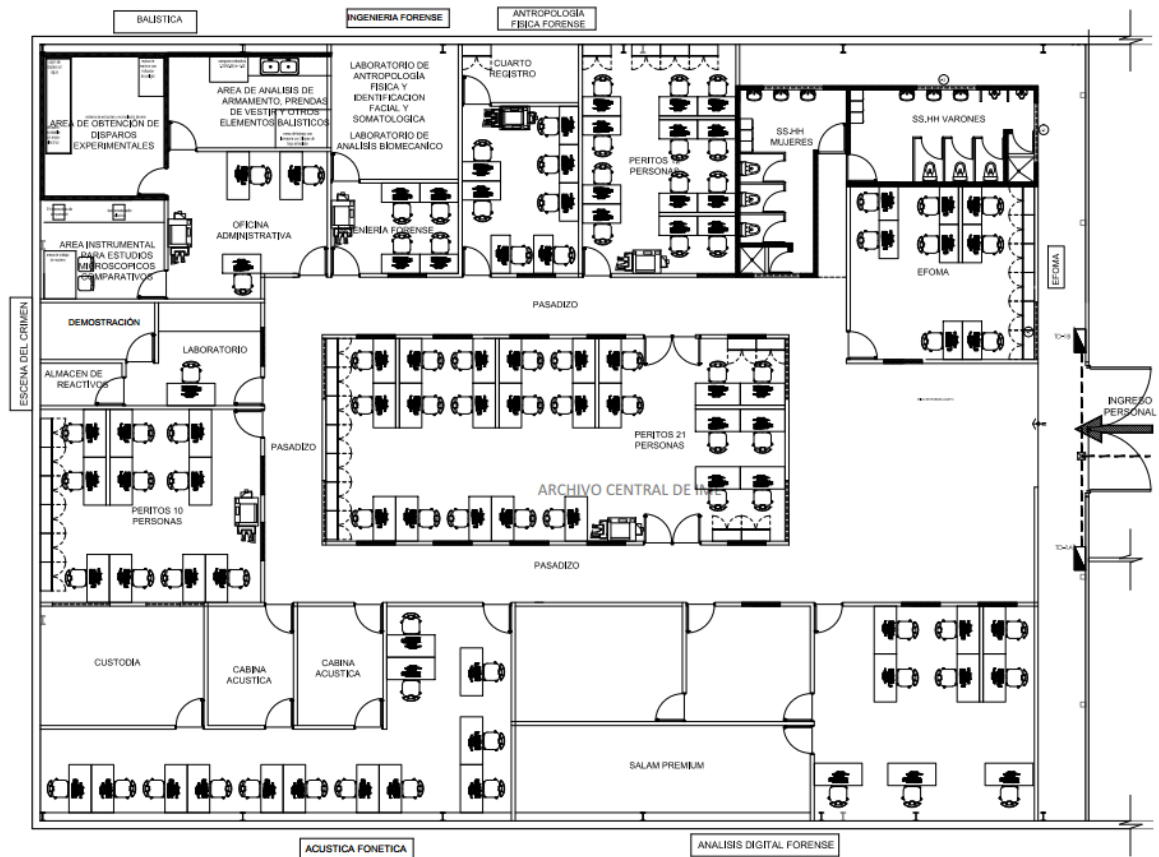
Plano arquitectónico del Ministerio Publico de Lima
